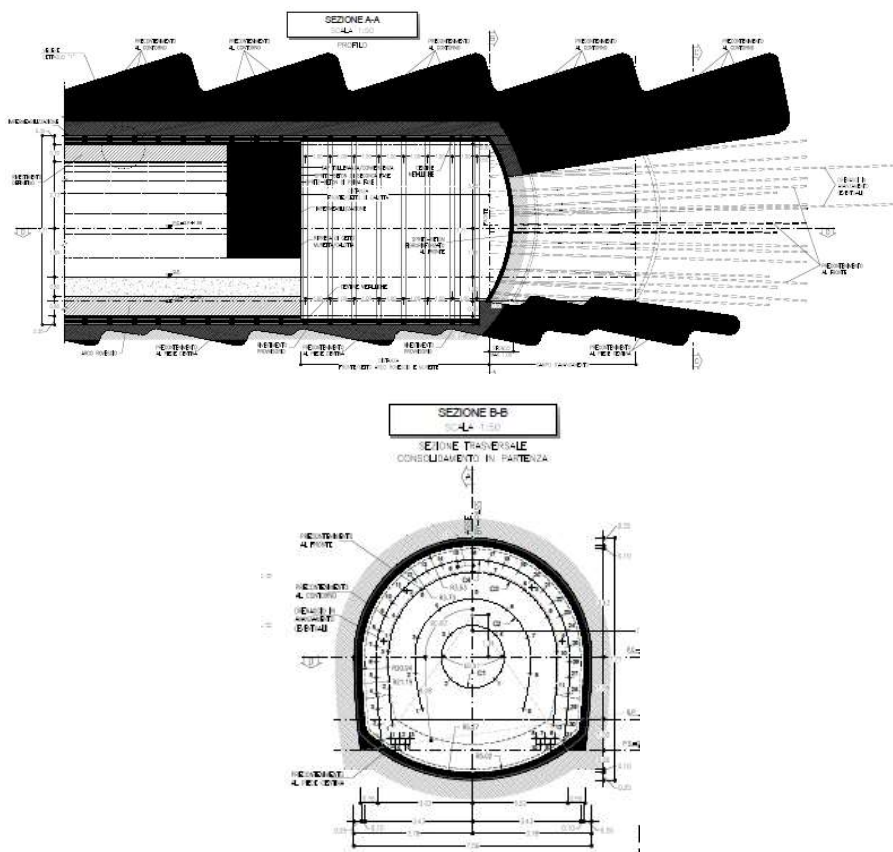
Sezione tipo C2p bypass area di sicurezza
